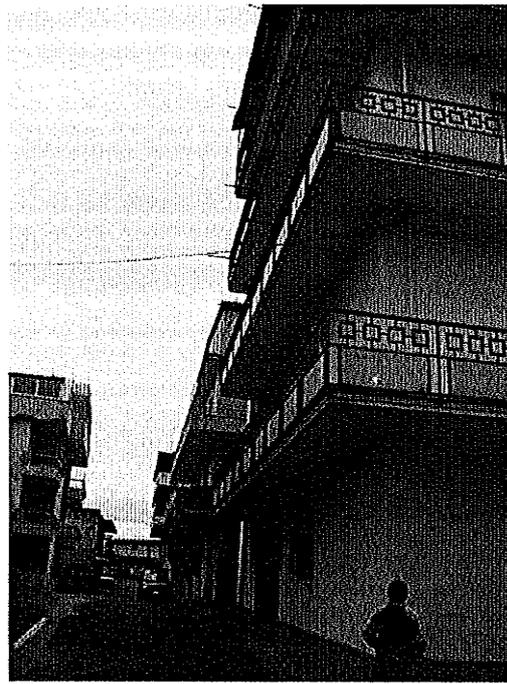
Particolare Prospetto su traversa di via C. Colombo
